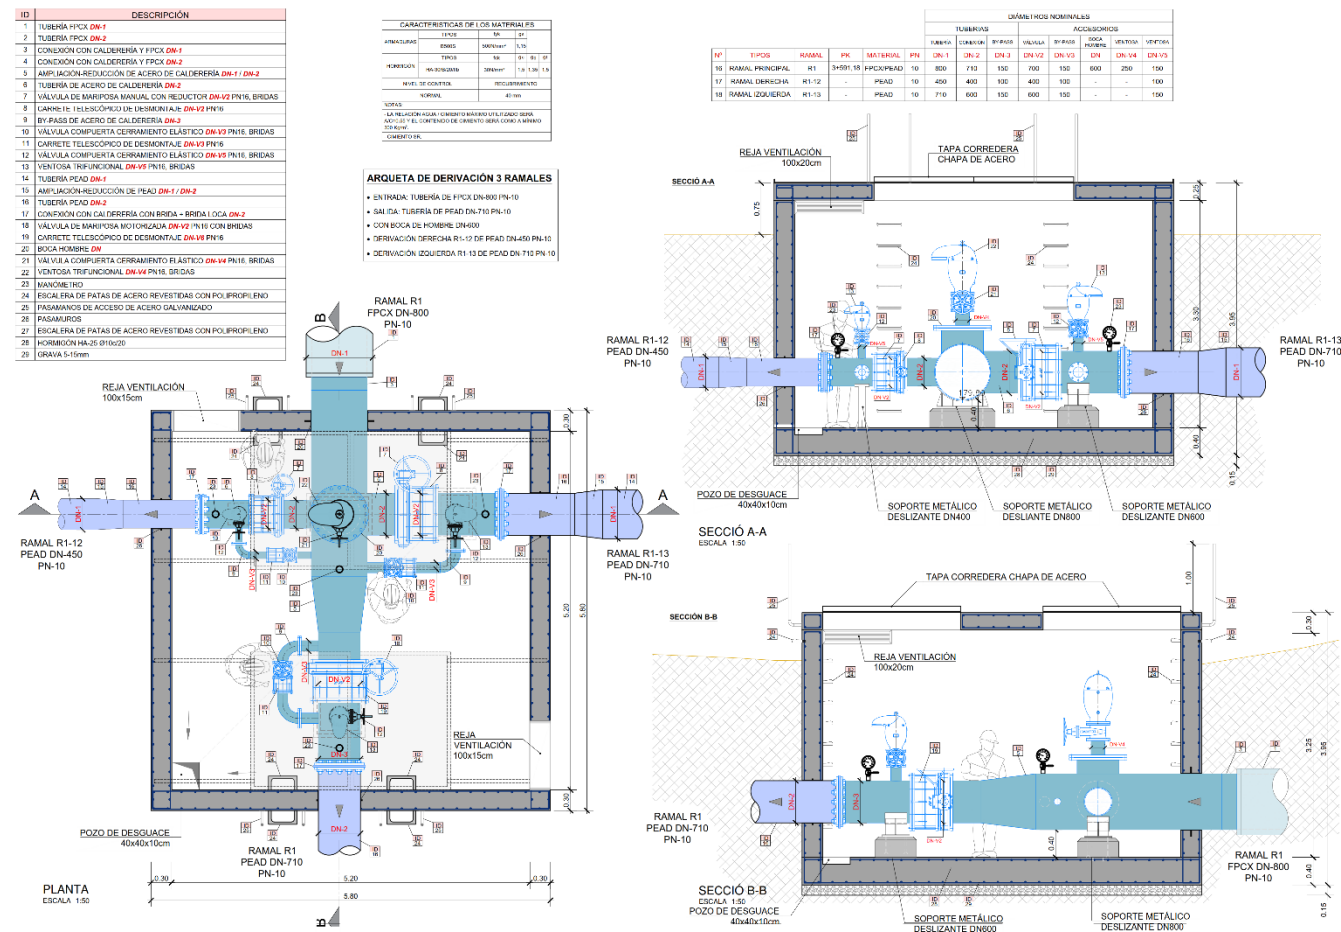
Seccionamiento nº 3 y seccionamientos nº 8-9-10, 11-12-13 y 16-17-18 de tipo ATFP. Diferentes PQ del ramal R1.
